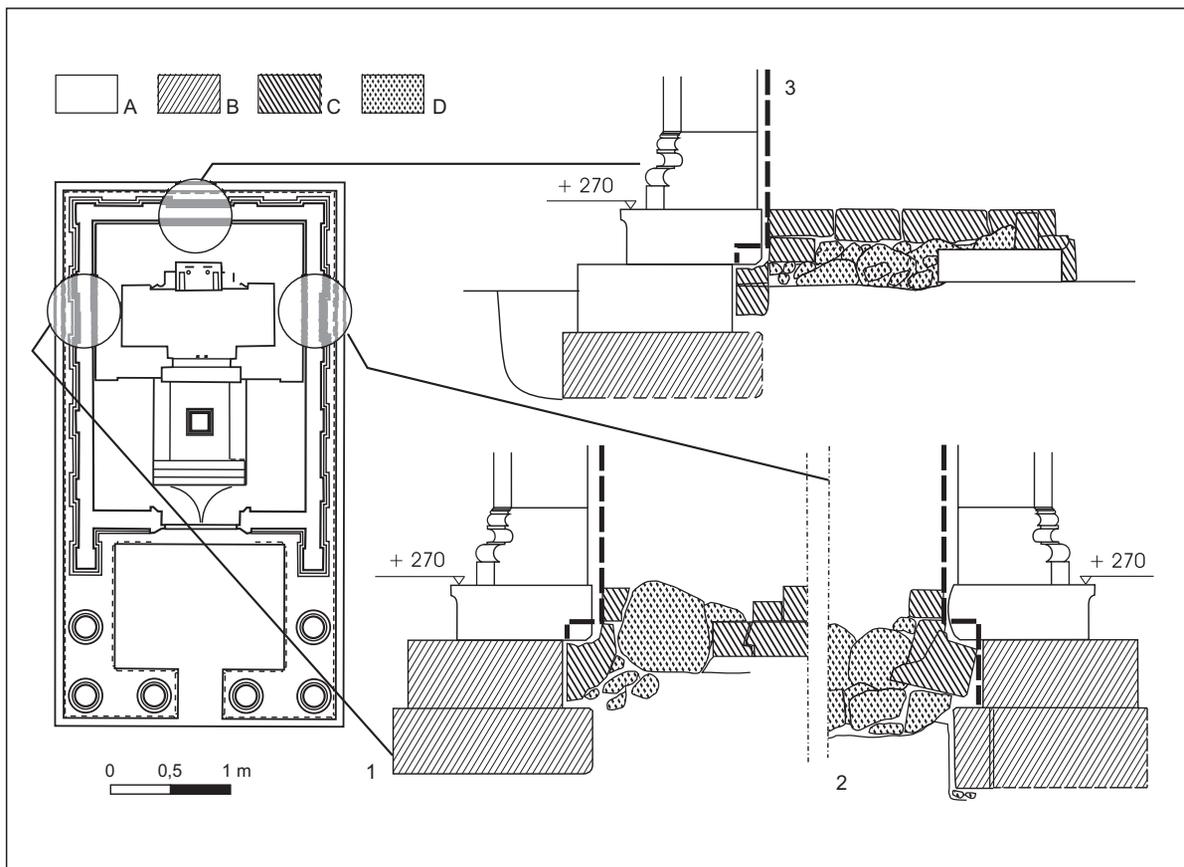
Coupes par les fondations du naos: 1 – mur sud, 2 – mur nord, 3 – mur ouest; A – parois du temple ALLAT III, B – fondations du temple, C – parties apparentes du *hamana*, D – blocage des mur du *hamana
